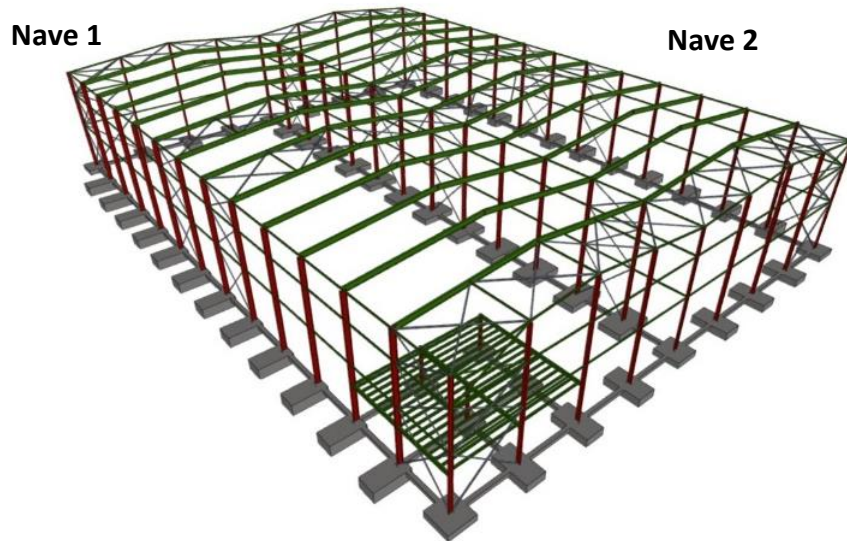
Vista 3D de la estructura. Fuente: CYPE 3D.
